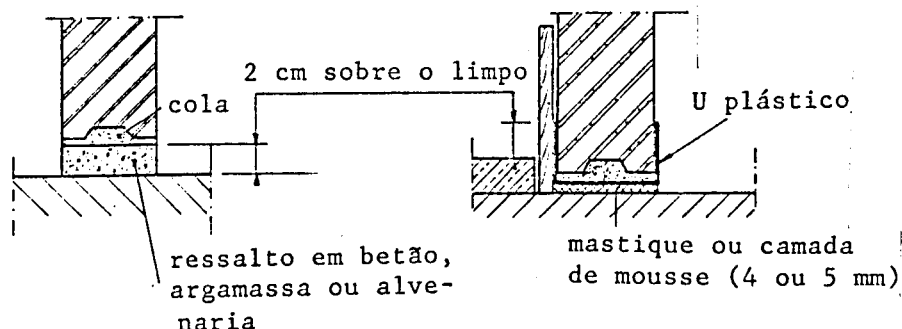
Pormenor de ligação da divisória amovível com o pavimento em zonas húmidas.
